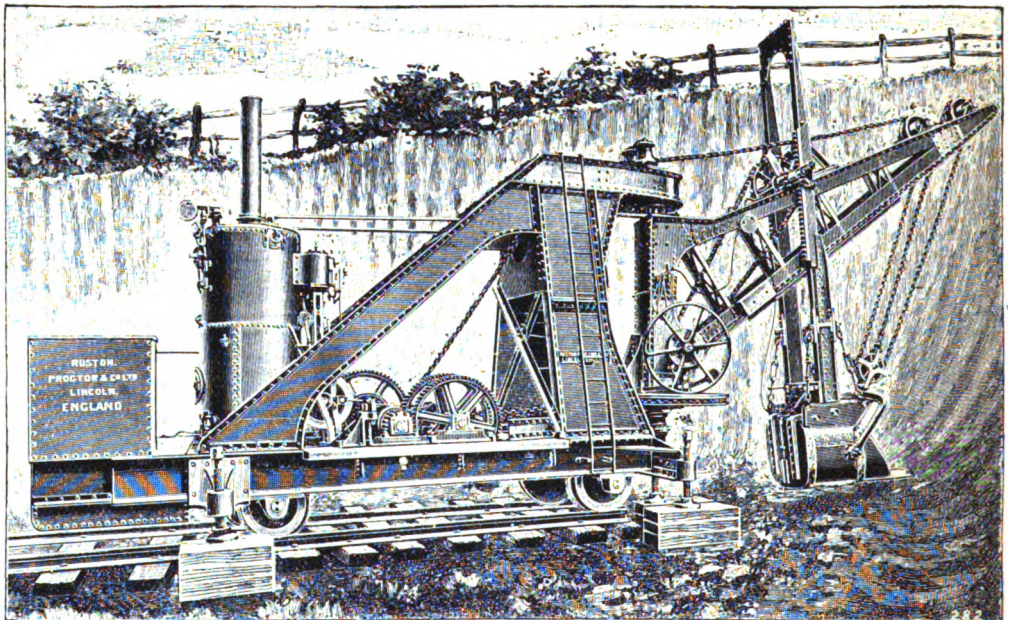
Dampfexcavator von Ruston, Proctor & Co., lim., in Lincoln.
